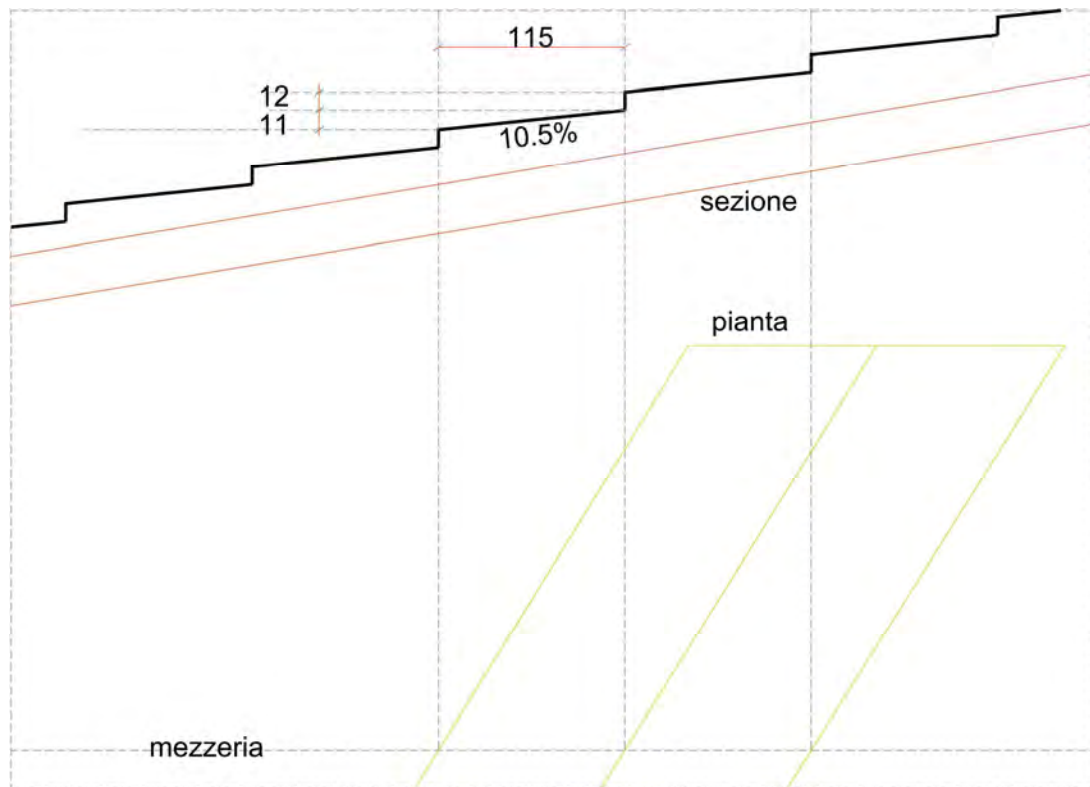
Profilo altimetrico e sezione tipo della nuova via gradinata
